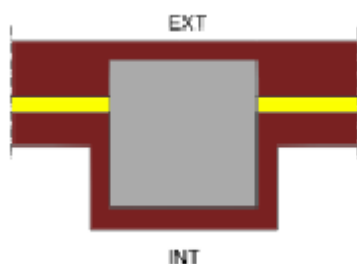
Aislamiento interrumpido por el pilar. Fuente: CTE DB HE3 Puentes térmicos.
